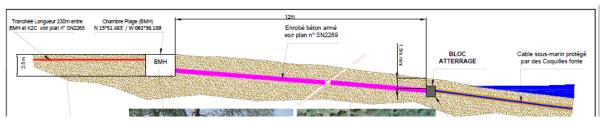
Profil en coupe type de l'arrivée d'un câble d'atterrage
